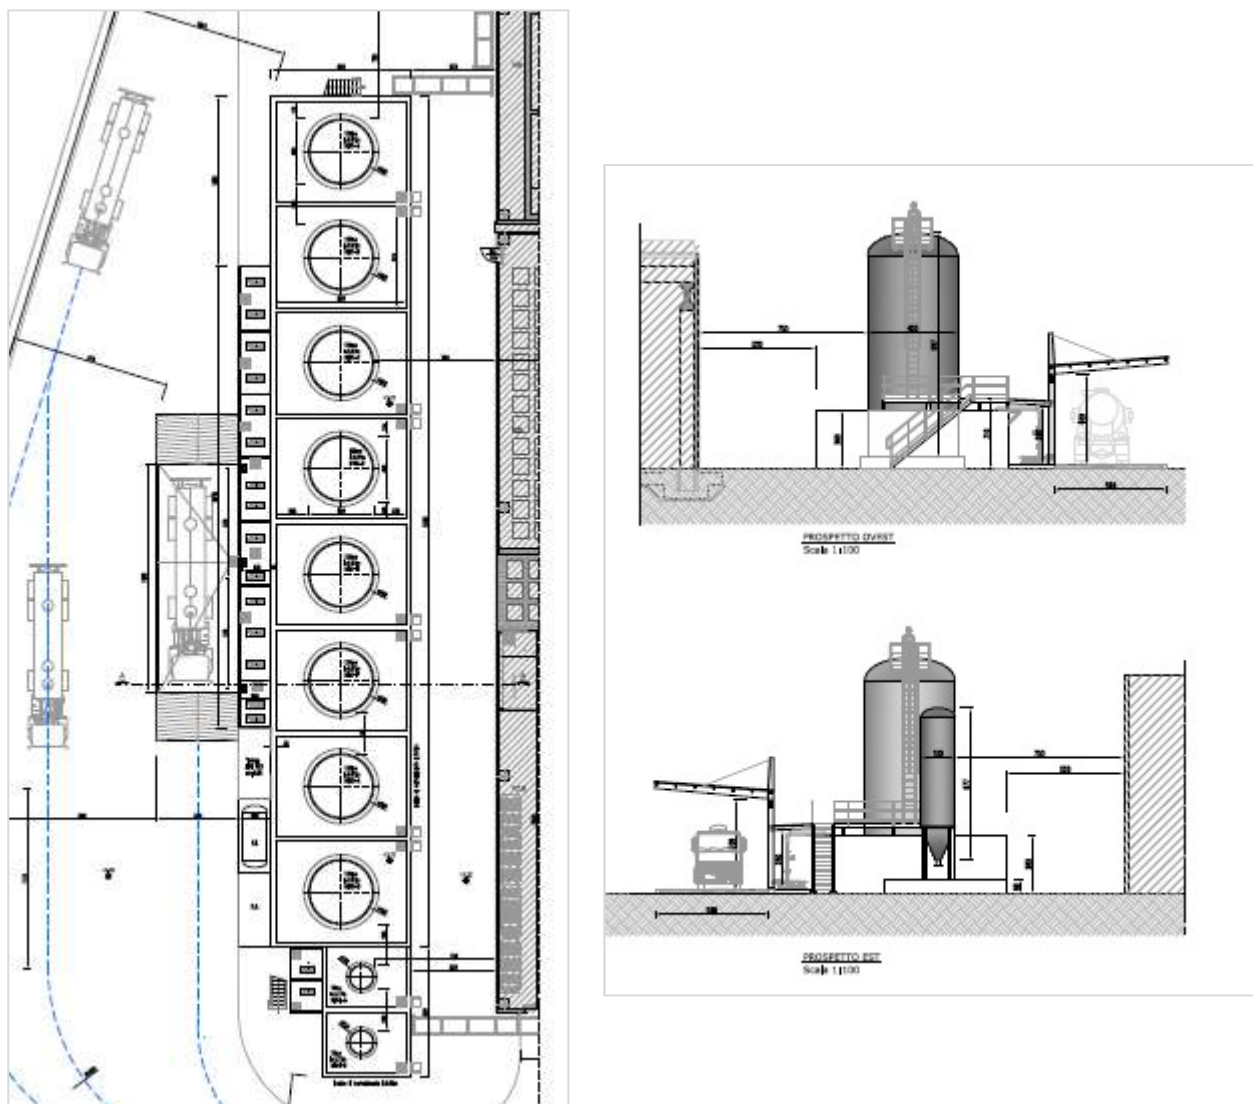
Dettaglio localizzazione Sezione N9 (dx) e prospetti EST/OVEST (sx) (Stralci elaborati CO 05 RA VA 00 D1 PL 54.00 - N9 PIANTE e CO 05 RA VA 00 D1 PL 55.00 - N9 PROSPETTI E SEZIONI )
